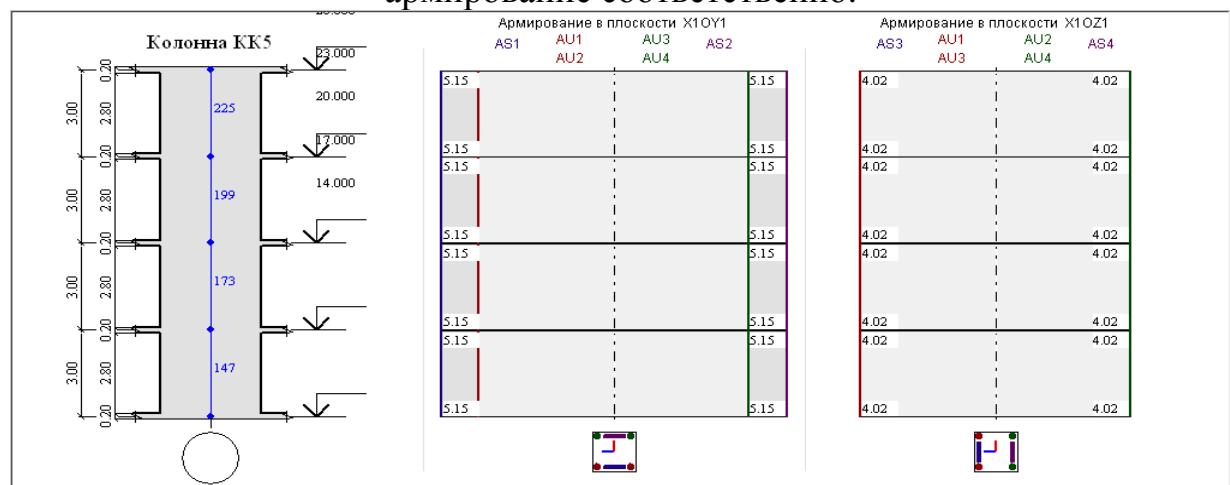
Армирование колонны 6-9 этажей схемы. Поперечное и продольное армирование соответственно.
